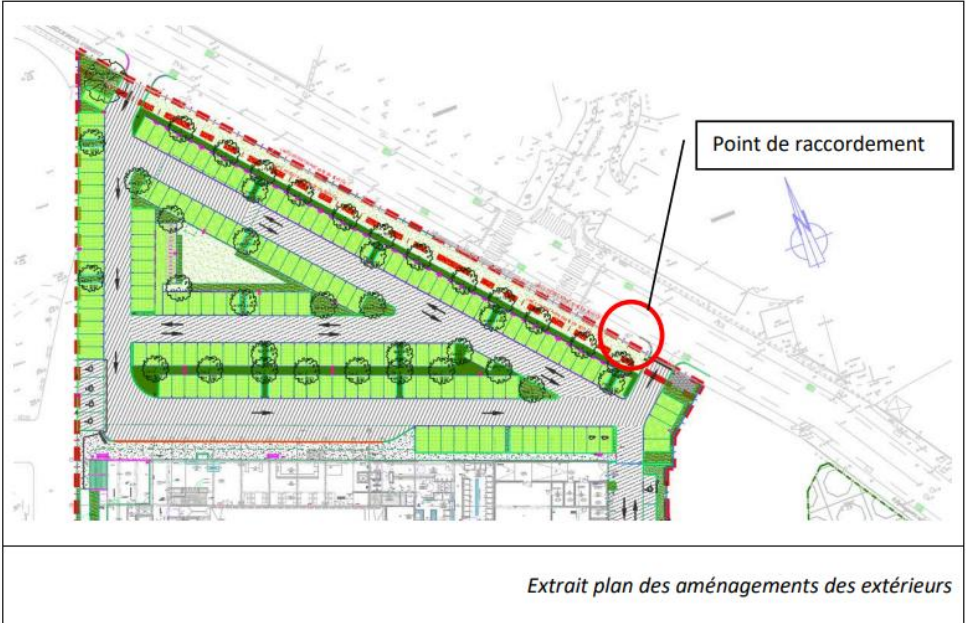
Extrait du plan de raccordement réseaux du stade nautique (Source : Eiffage Construction, PCM2)
